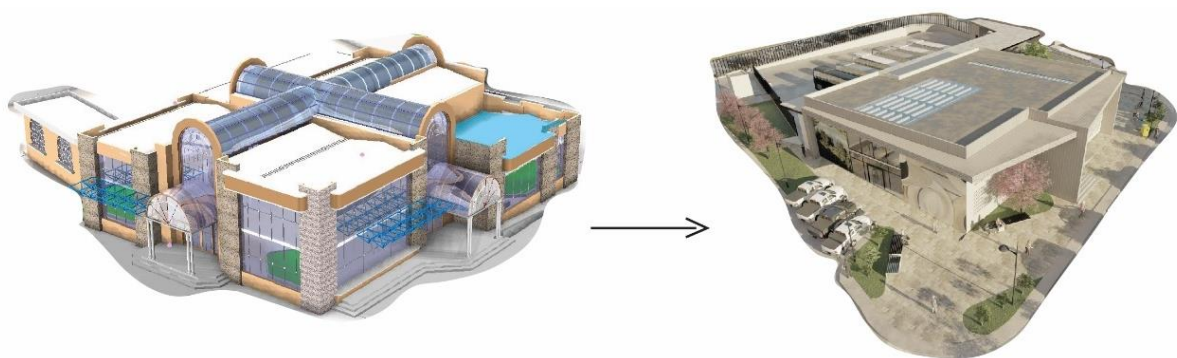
Comparación de intervención planta alta estado actual-propuesta.
